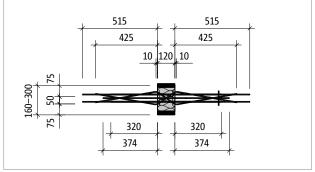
Schöck Isokorb® XT Typ W-M1: Produktgrundriss
